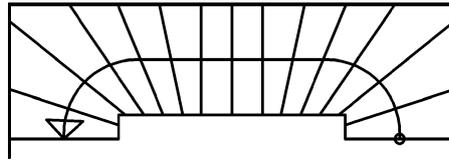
Einläufige, zweimal viertelgewendelte Treppe
